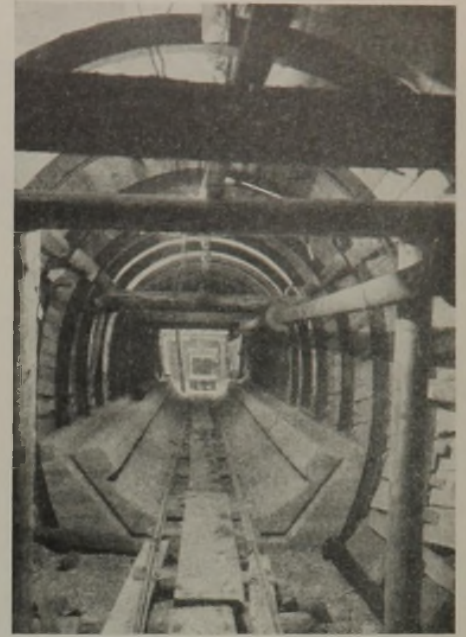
Kanal Eisenheimer Straße: Sohlenbeton mit Aussparung für die Klinkerrollschicht.
